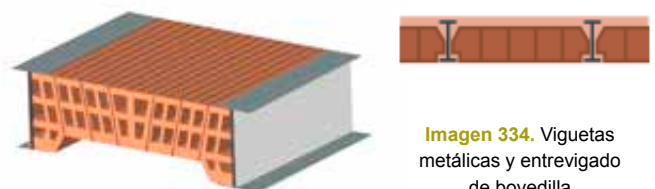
Viguetas metálicas y entrevigado de bovedilla
